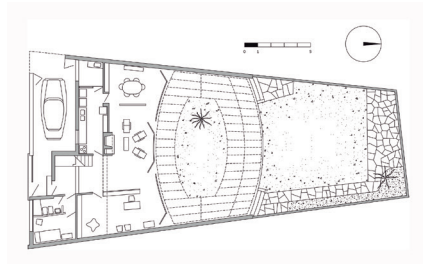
Planta baja del proyecto para la casa Tedeschi (fuente: Elaboración propia, 2011).
